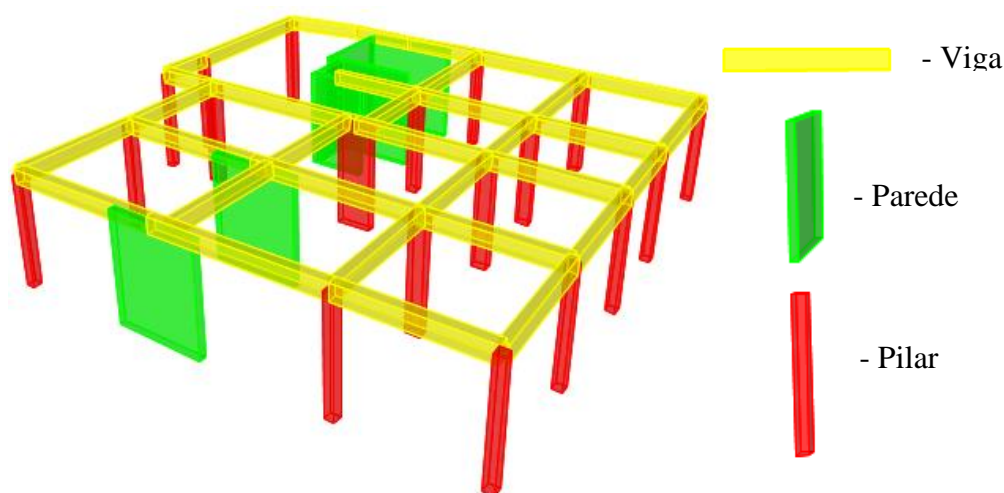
Representação das vigas, paredes e pilares do piso tipo.
